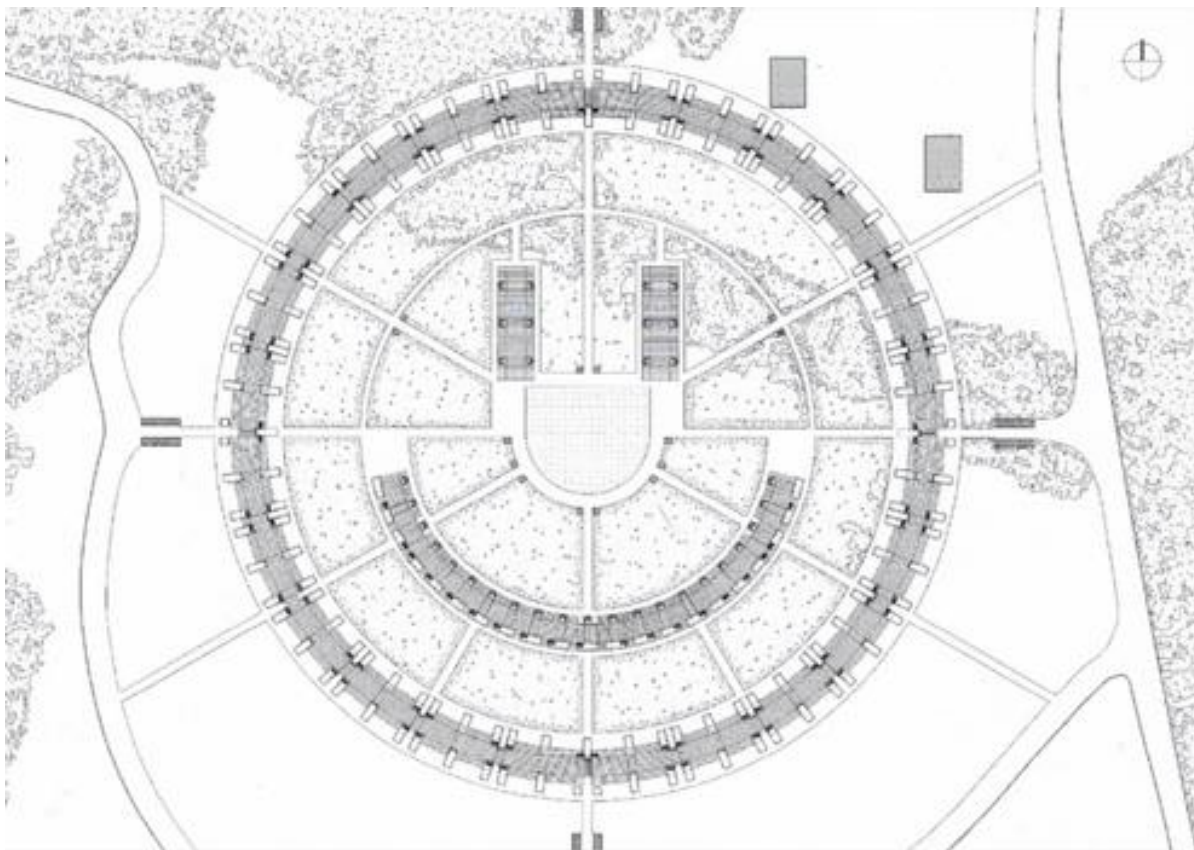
Planta arquitectónica Happy City. Garrido (2015)
